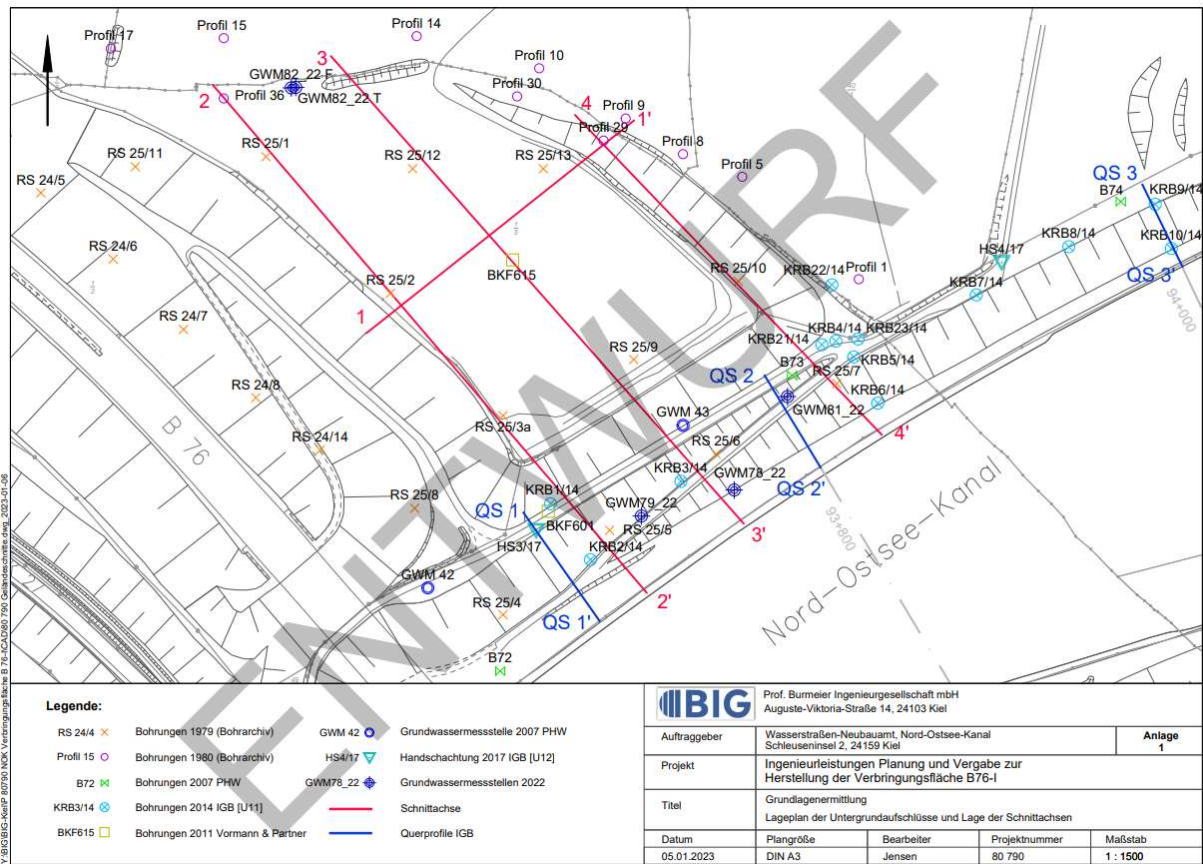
Lageplan der Untergrundaufschlüsse und Lage der Schnittachsen, Anlage 1 aus Grundlagenermittlung
